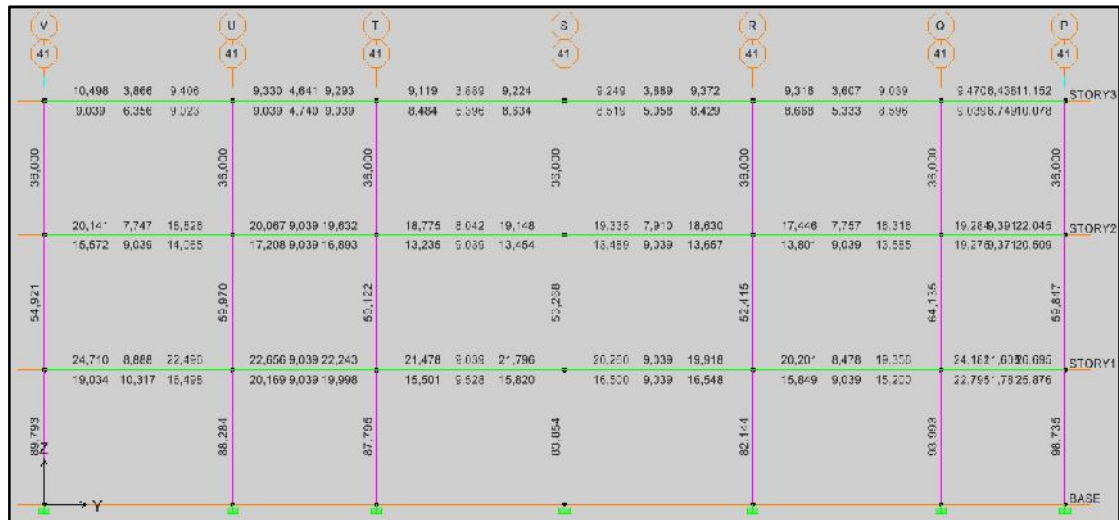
Acero en vigas pórtico 41, Consulta Externa I
